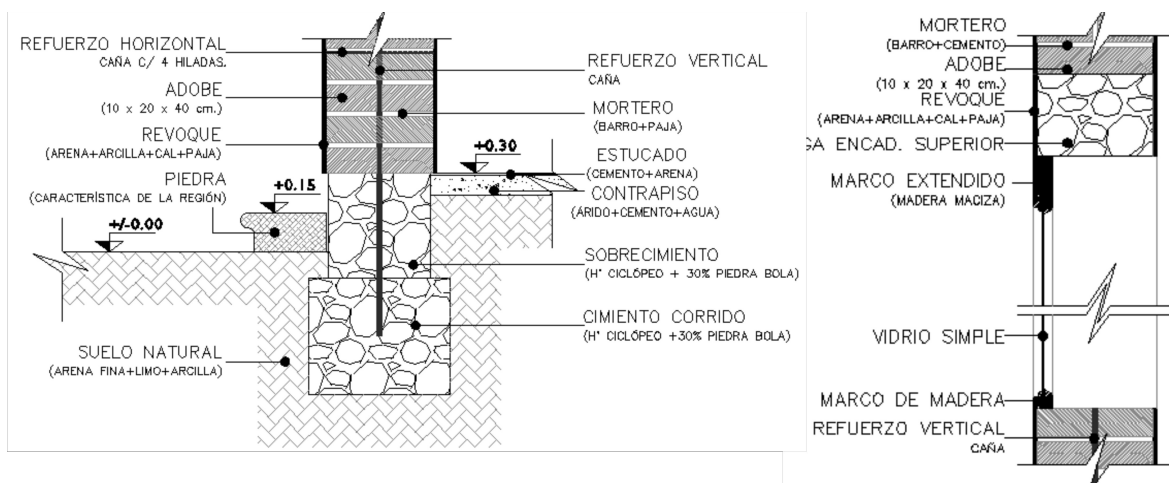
Detalles del sistema constructivo para muros en adobe y caña: cemento, sobrecimiento, viga de encadenado superior y carpintería.
